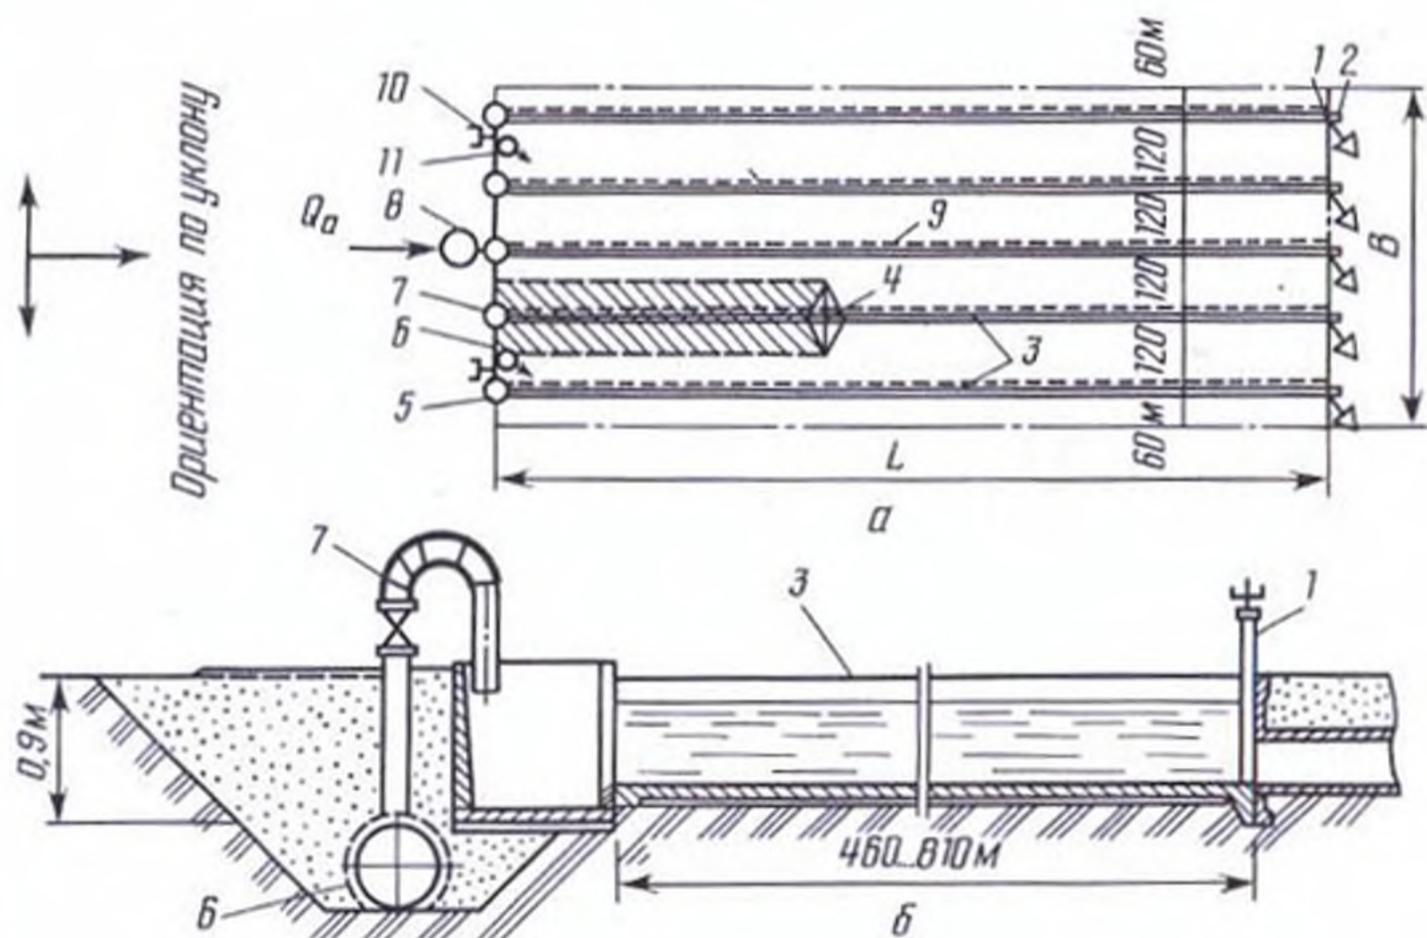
Схема поливного модуля с двухконсольным дождевальным агрегатом ДДА-100МА, сетью из асбестоцементных труб, открытыми оросителями с монолитной бетонной облицовкой, подводом воды к торцу модульного участка (а) и его монтажа (б) (условные обозначения по табл. 3.63)
